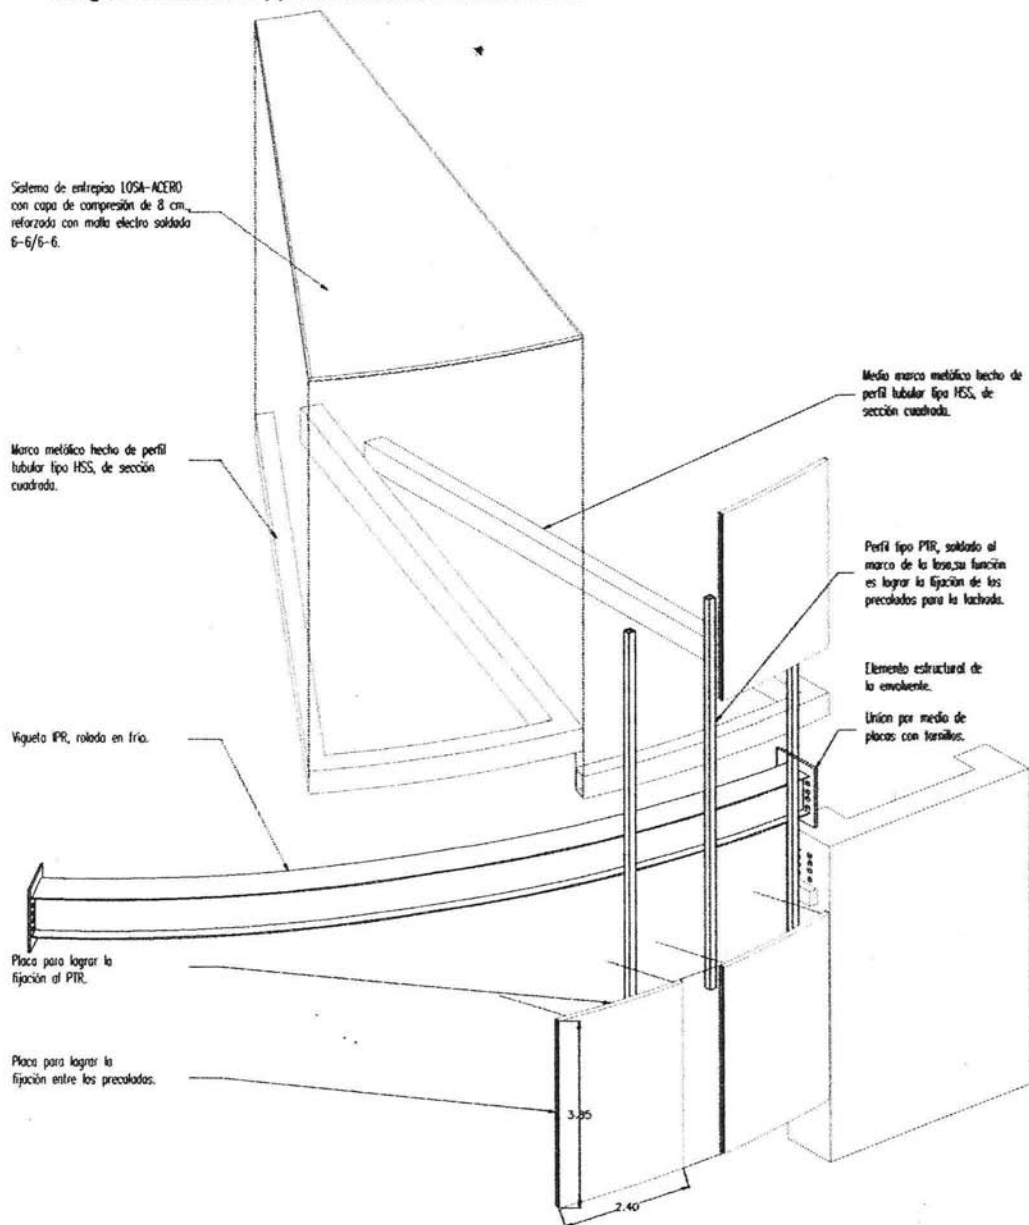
Disposición de los elementos estructurales por piso en la torre CIMENTACIÓN.
